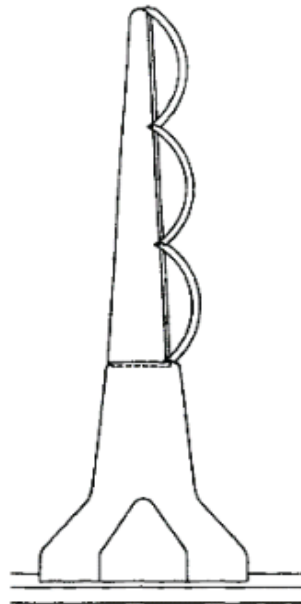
Кріплення опуклих дугових профілів до вертикального бетонного стовпа [25]
